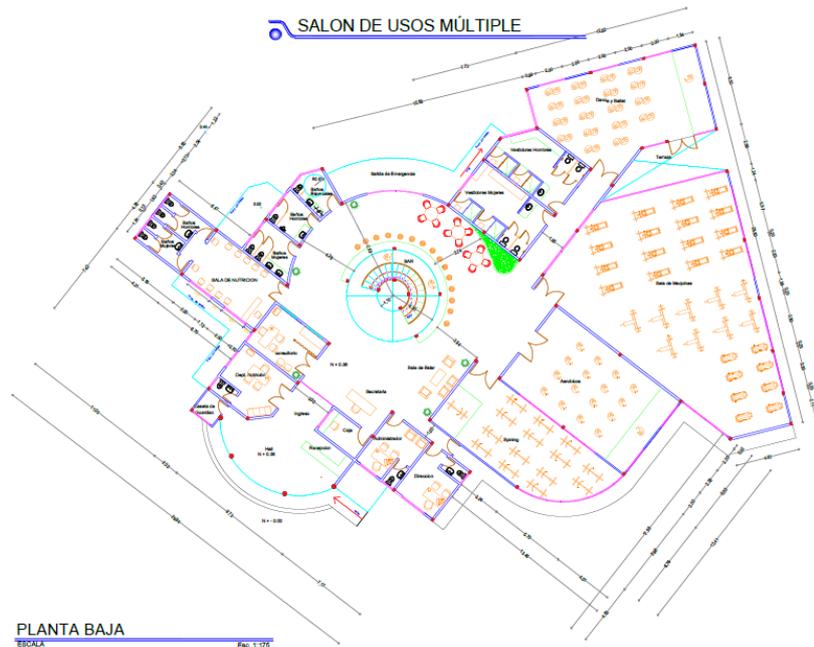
Planta Baja de Salón de usos múltiples y administración.
